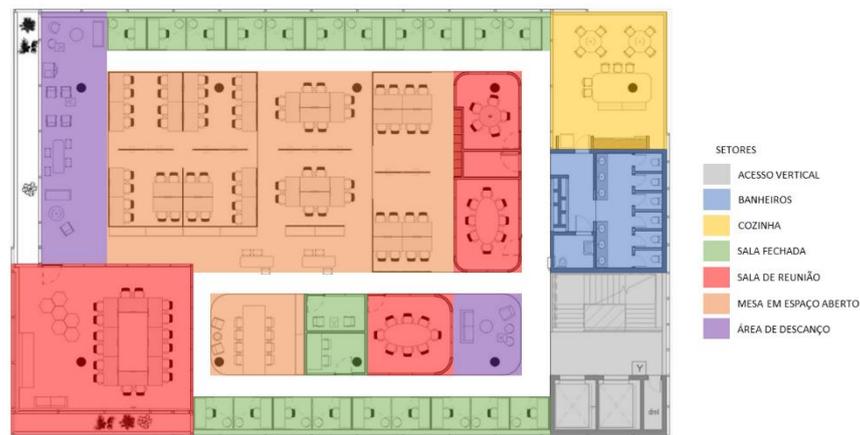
Setorização – Escritórios Alice, Planta 2º Pavimento
